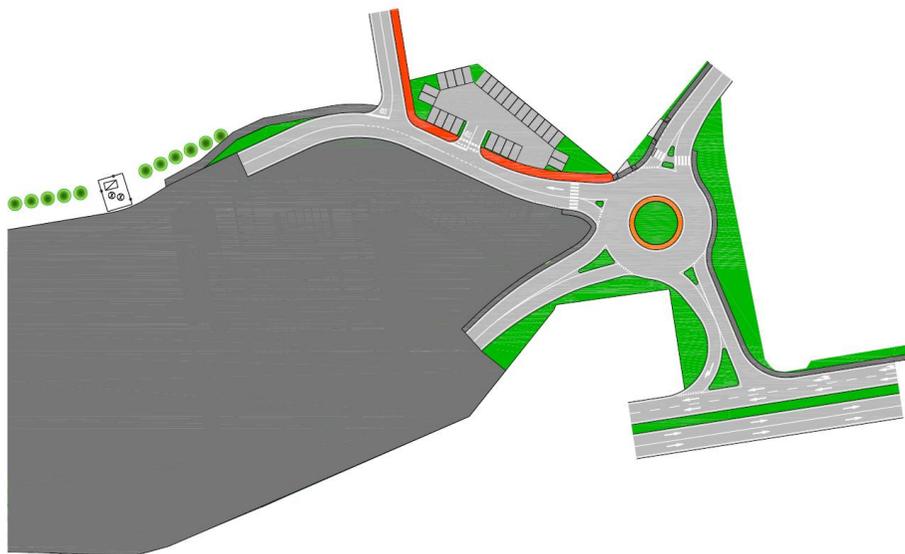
SC\_INT2 – Planimetria adeguamenti viabilità
